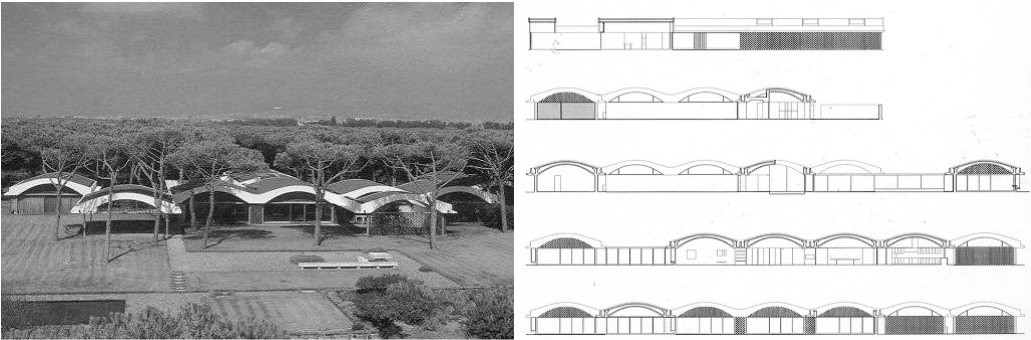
a | b Fotografía exterior y alzados y secciones de La Ricarda, Barcelona, 1949-1963, en las que se puede apreciar las bóvedas catalanas utilizadas en su construcción.
